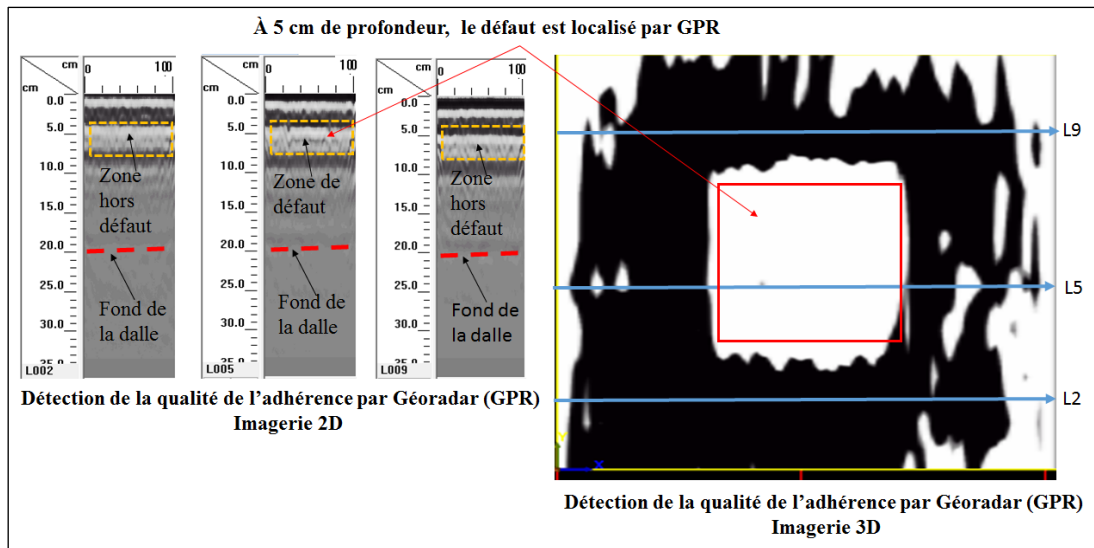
Détection de la qualité de l'adhérence par géoradar – Défaut placé à 5 cm de profondeur de la dalle - Dalle N° 1.
